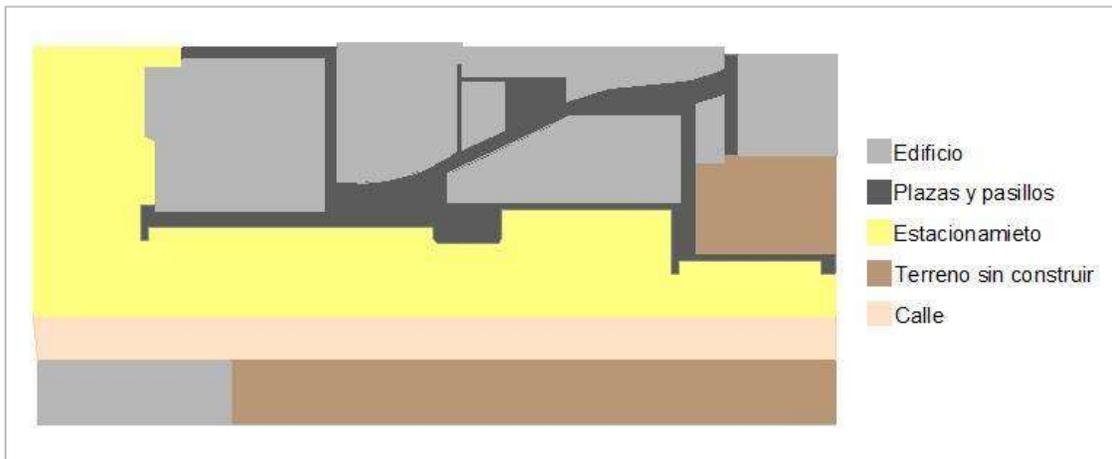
Planta de Plaza El Prado (Vega, L., 2016).
